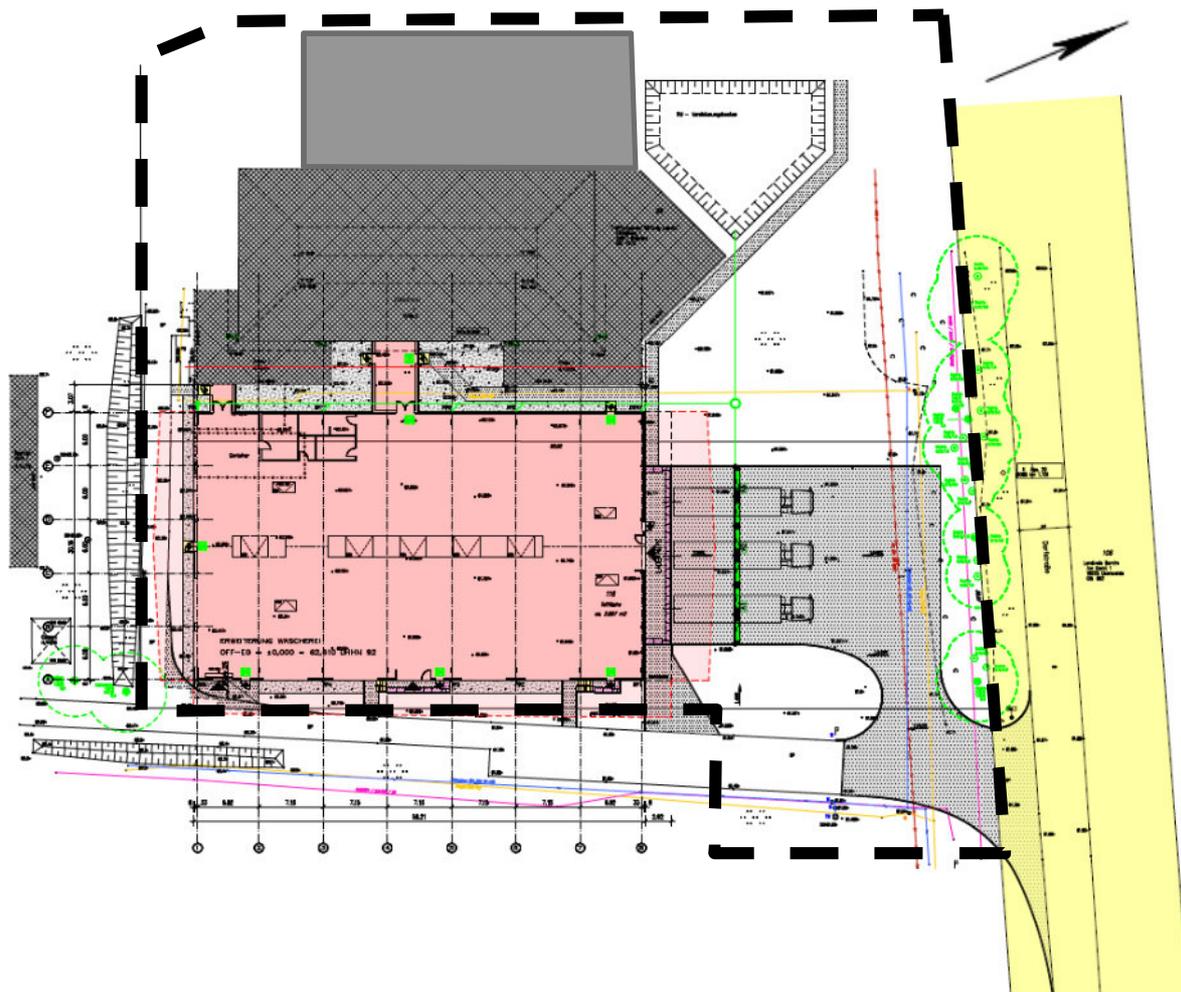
Bauungskonzept Erweiterungsbau Wäscherei (mit Plangebietsgrenze)
